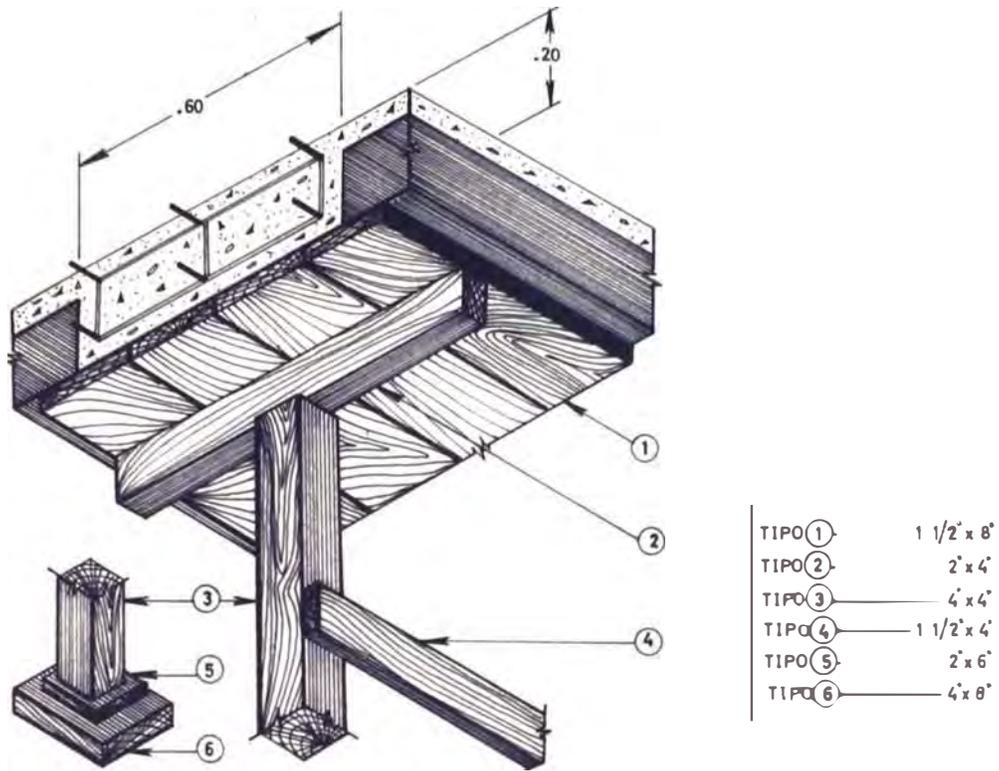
ENCOFRADO DE VIGA 1-V-2 CHATA . .60x.20m
